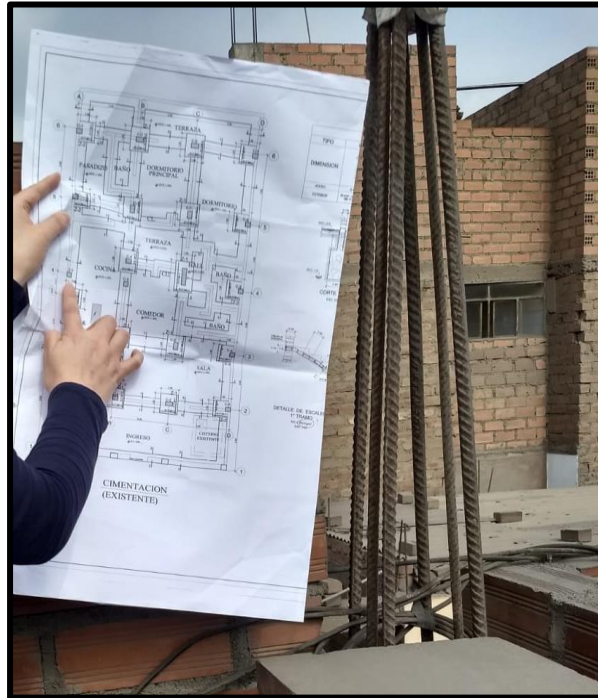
Ubicación de acero de columna C-3 de 6Ø1/2, corroborado con el cuadro de columnas en planos existentes.
